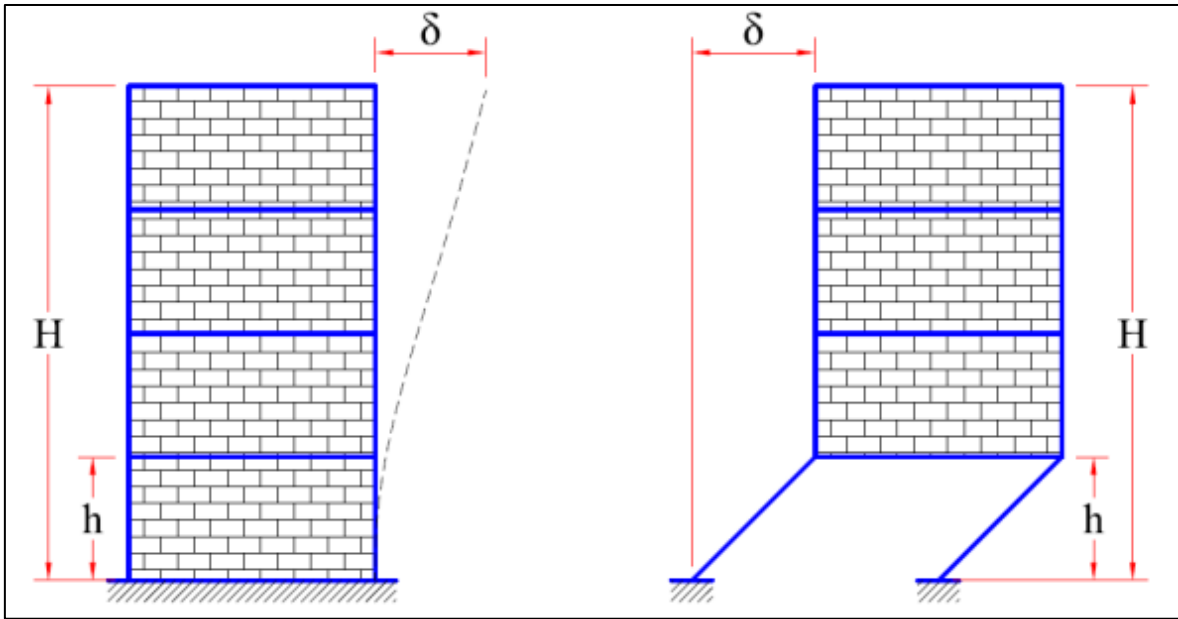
Desplazamientos laterales con muros divisorios en todos los niveles, y con planta baja débil.
